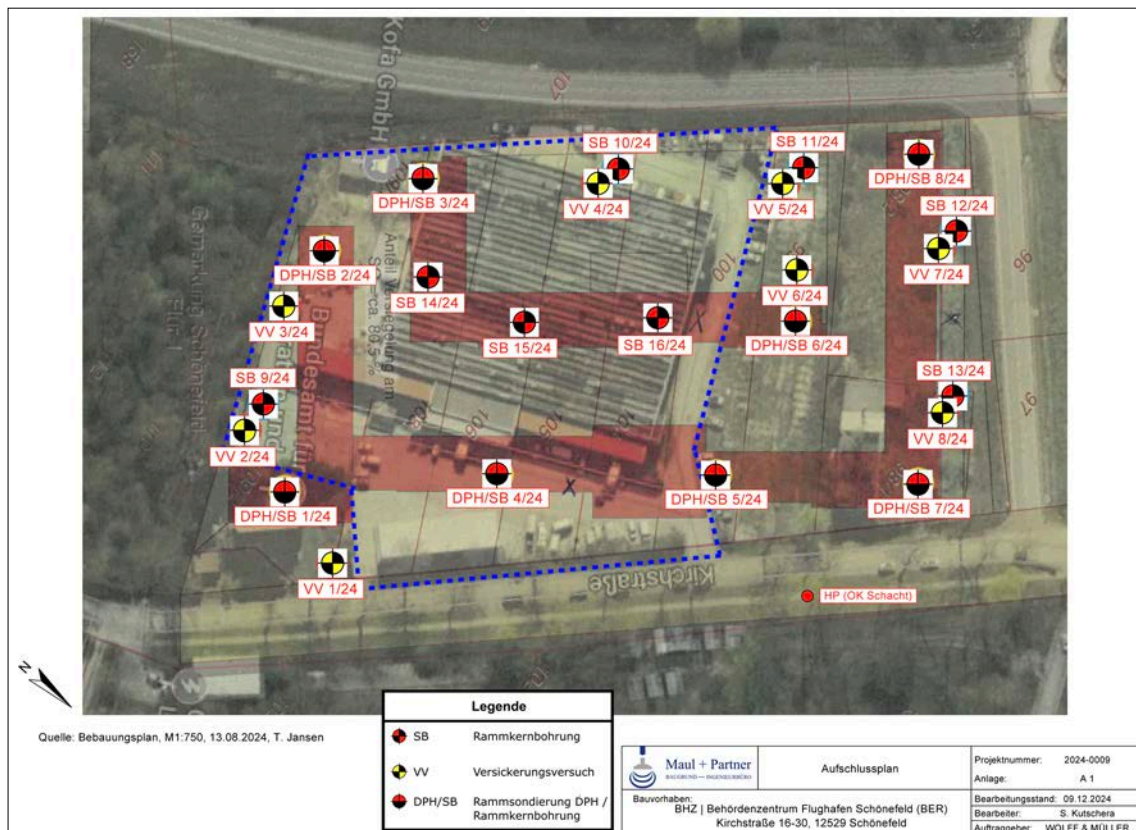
Aufschlussplan Sondergebiet "Behörden"
